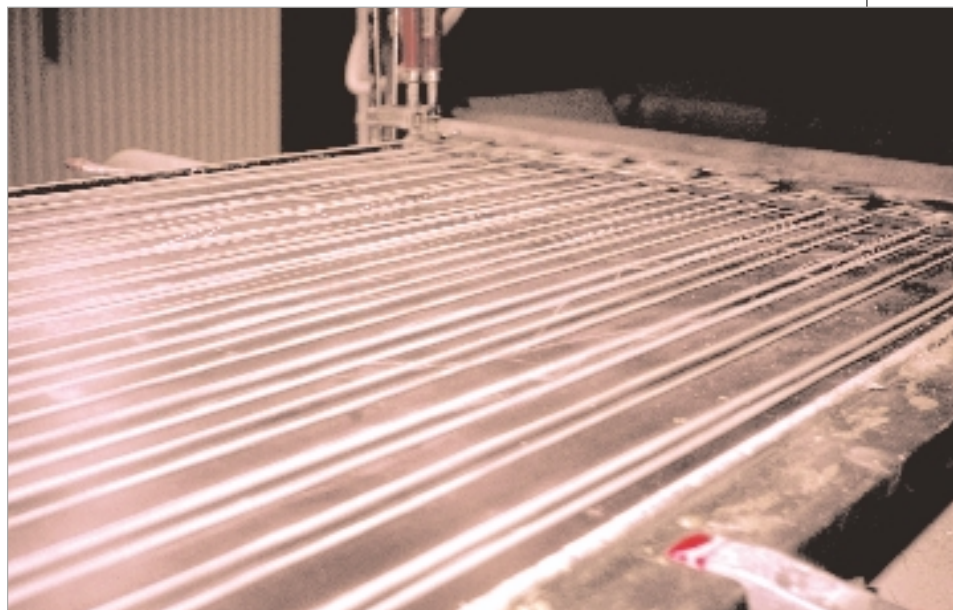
Positionierte textile Bewehrung für Plattenelemente
